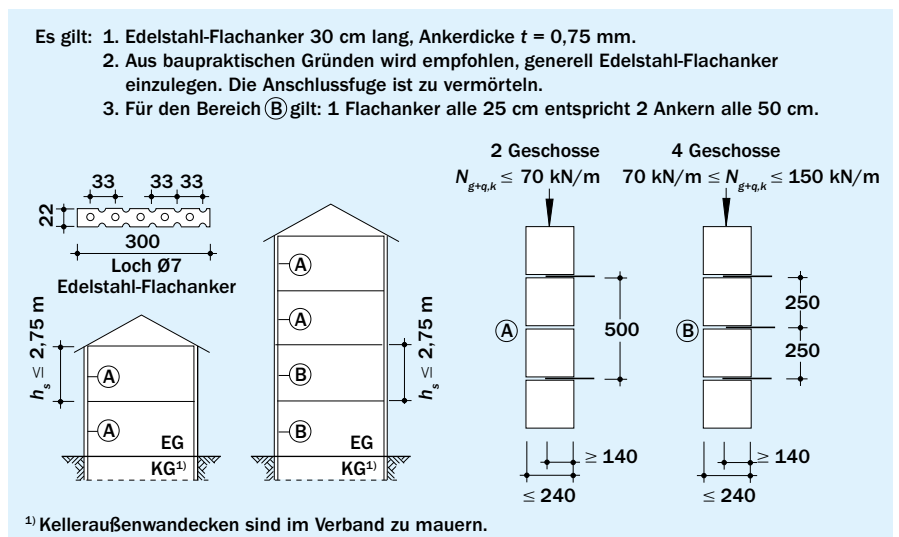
KS-Stumpfstoßtechnik, Regelausführung bei Annahme einer drei- oder vierseitigen Halterung der tragenden Wand (Schichthöhe ≤ 25 cm)
